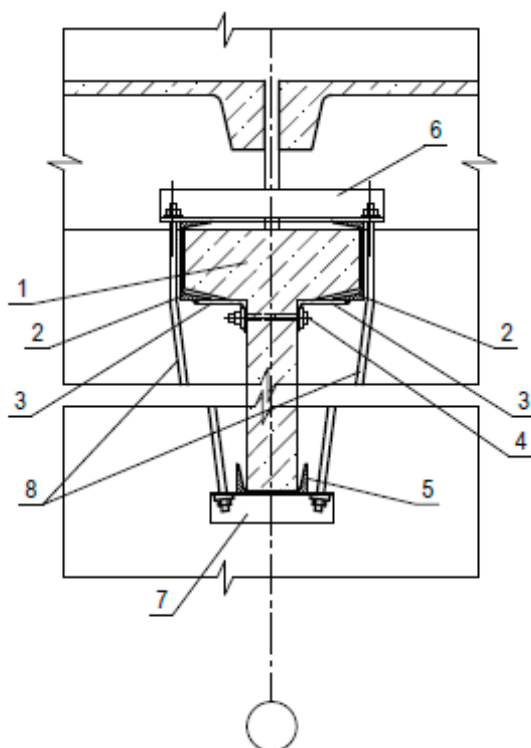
Устройство для усиления приопорной части железобетонных балок
